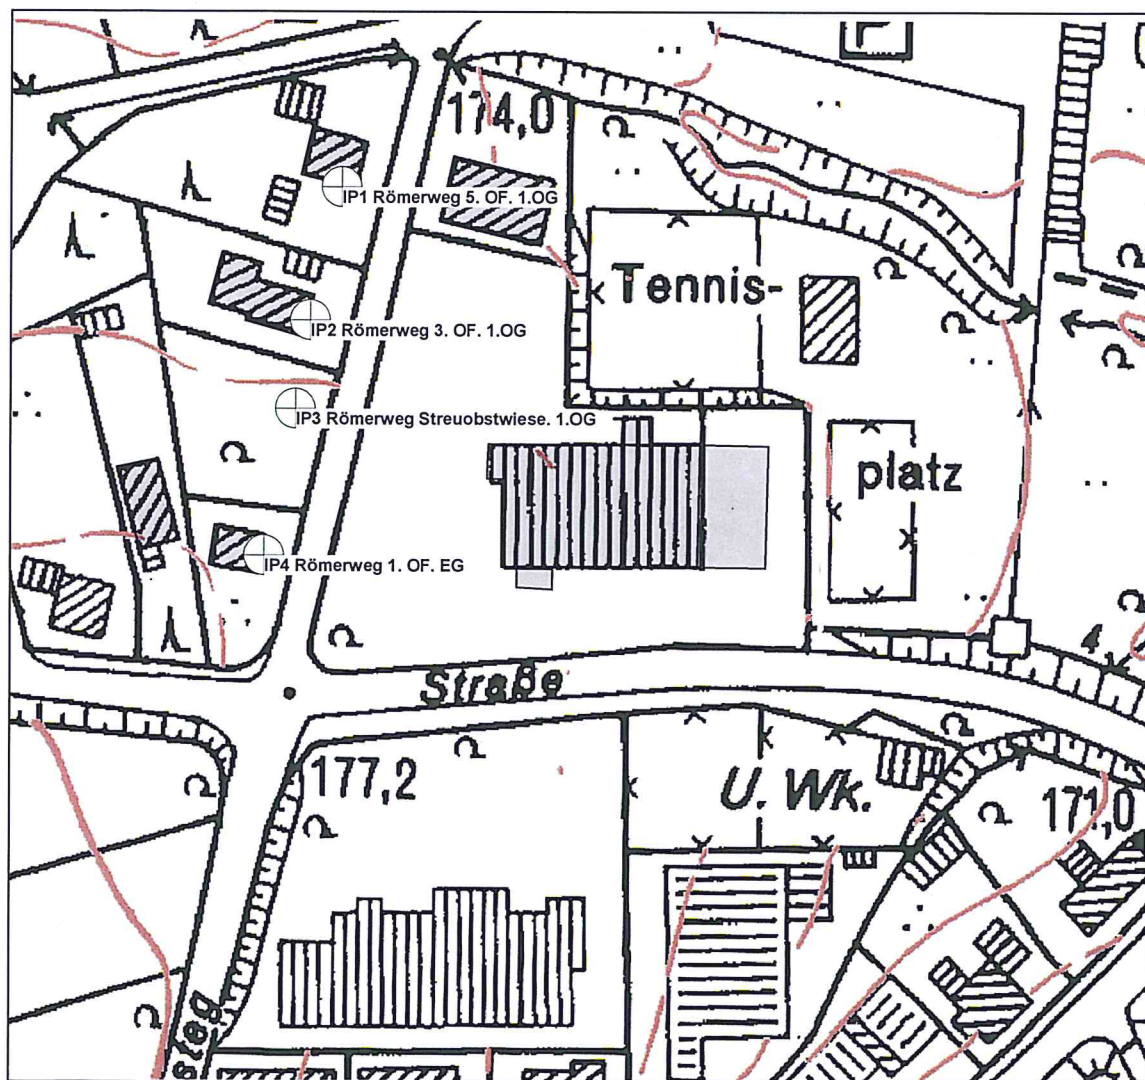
Lageplan mit Darstellung der Immissionsorte
